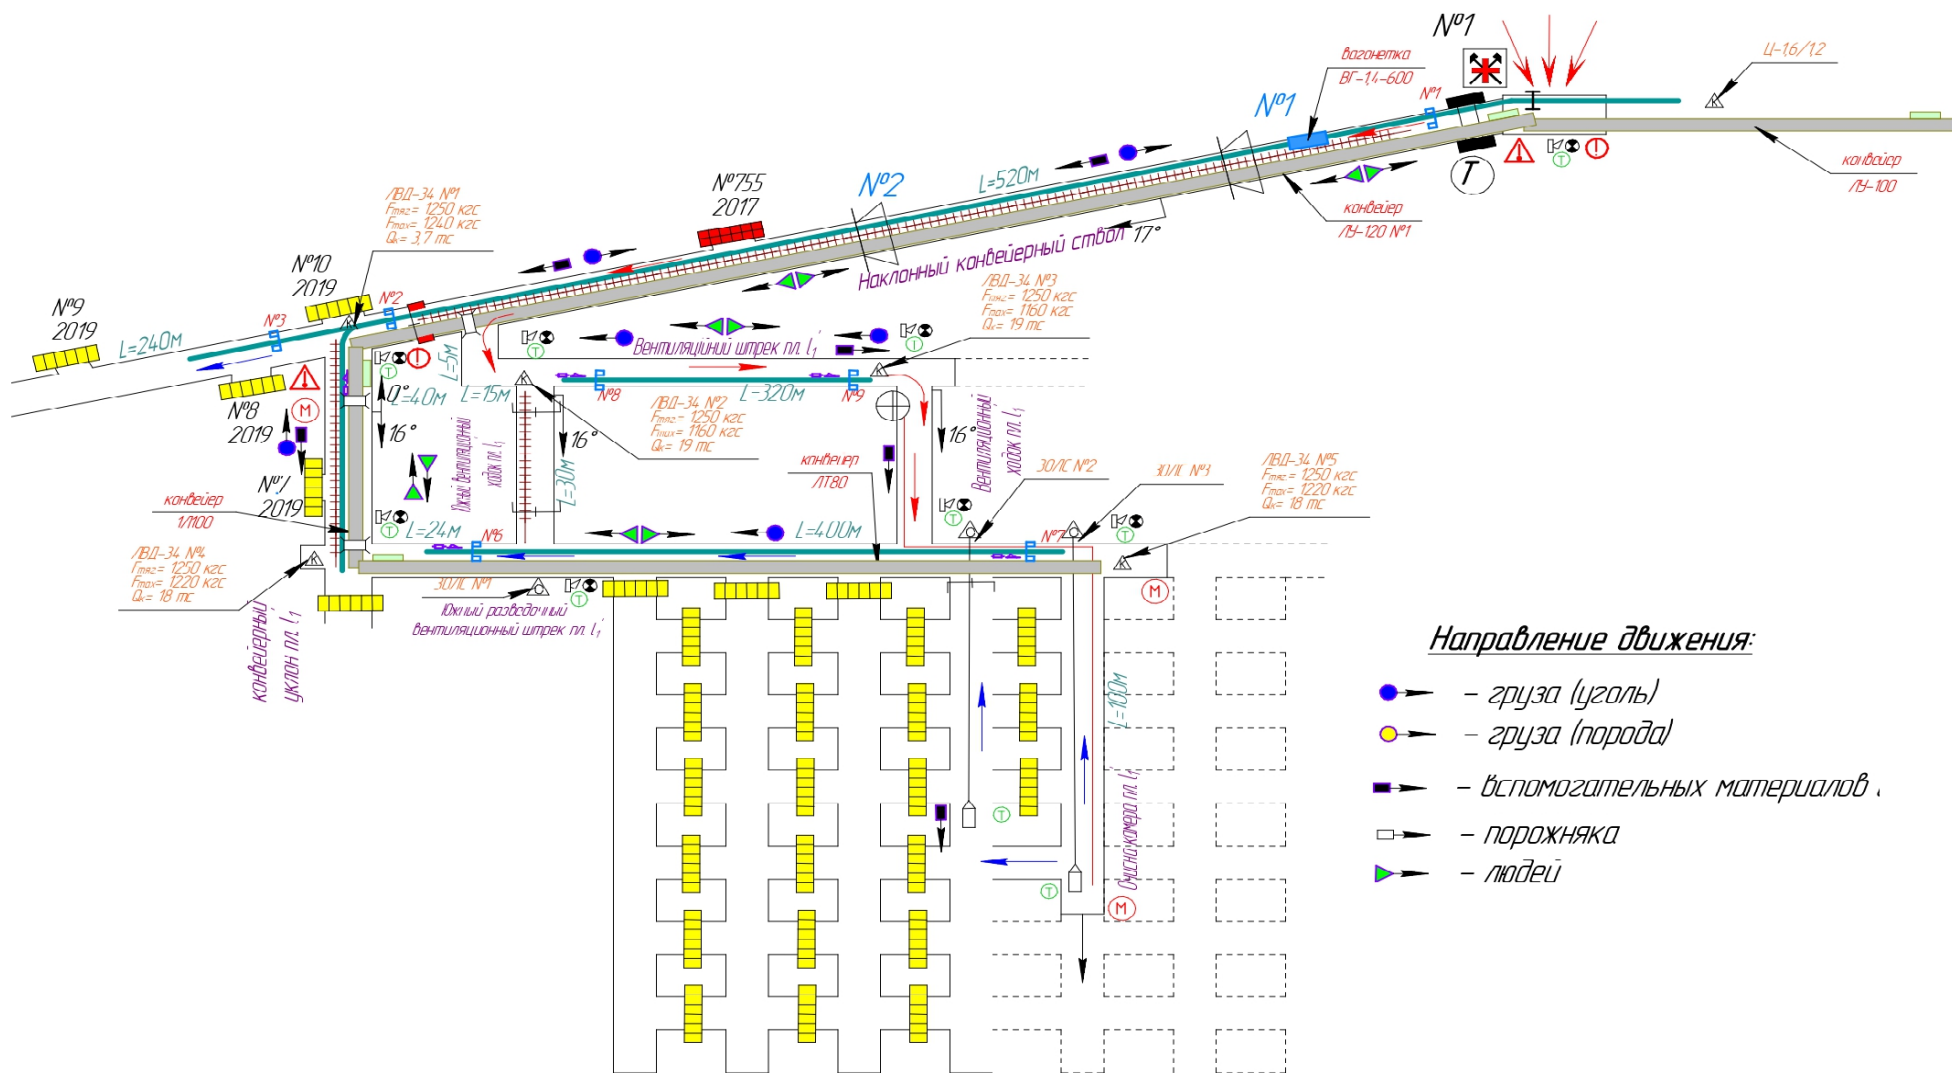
Схема камерно- стовпової підготовки блока №1 пласта l_1
